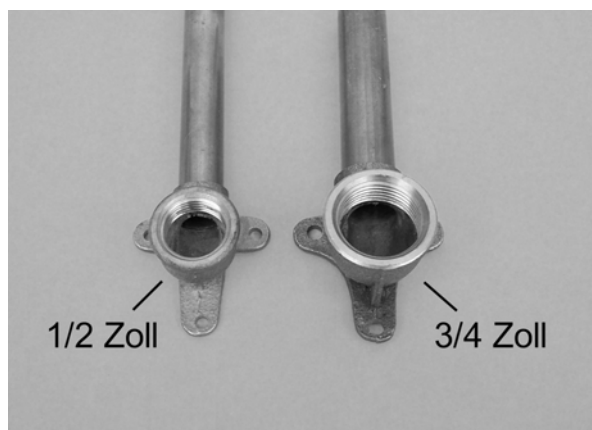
Deckenwinkel sind meistens mit einem 1/2" Zoll oder 3/4" Zoll-Innengewinde versehen.
